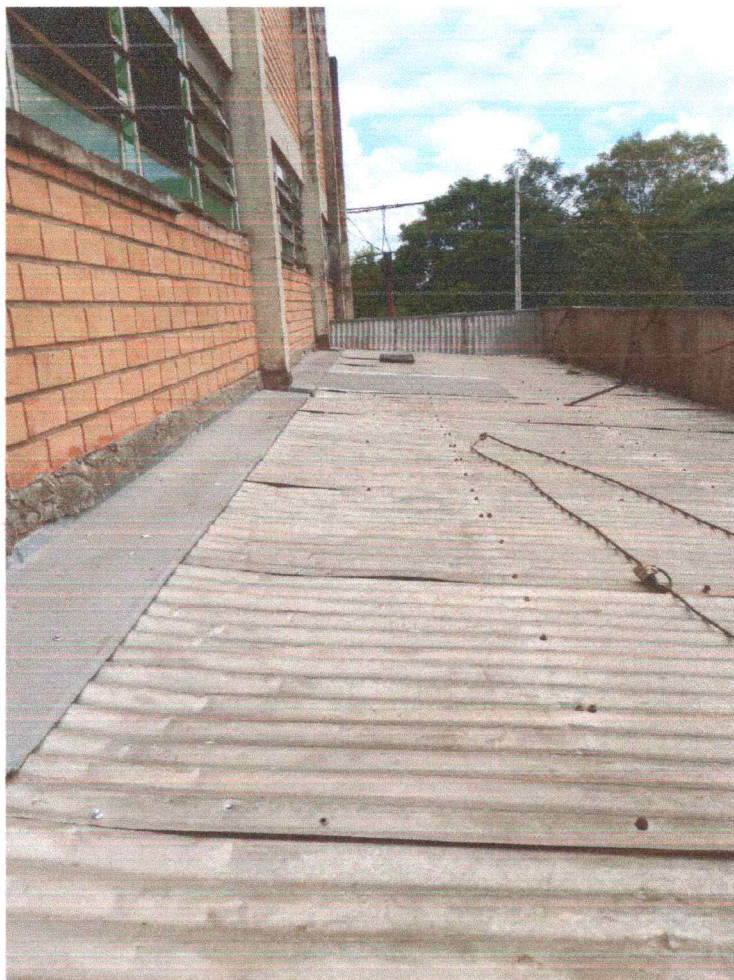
Fixação e vedação da telha do Hall de entrada.
